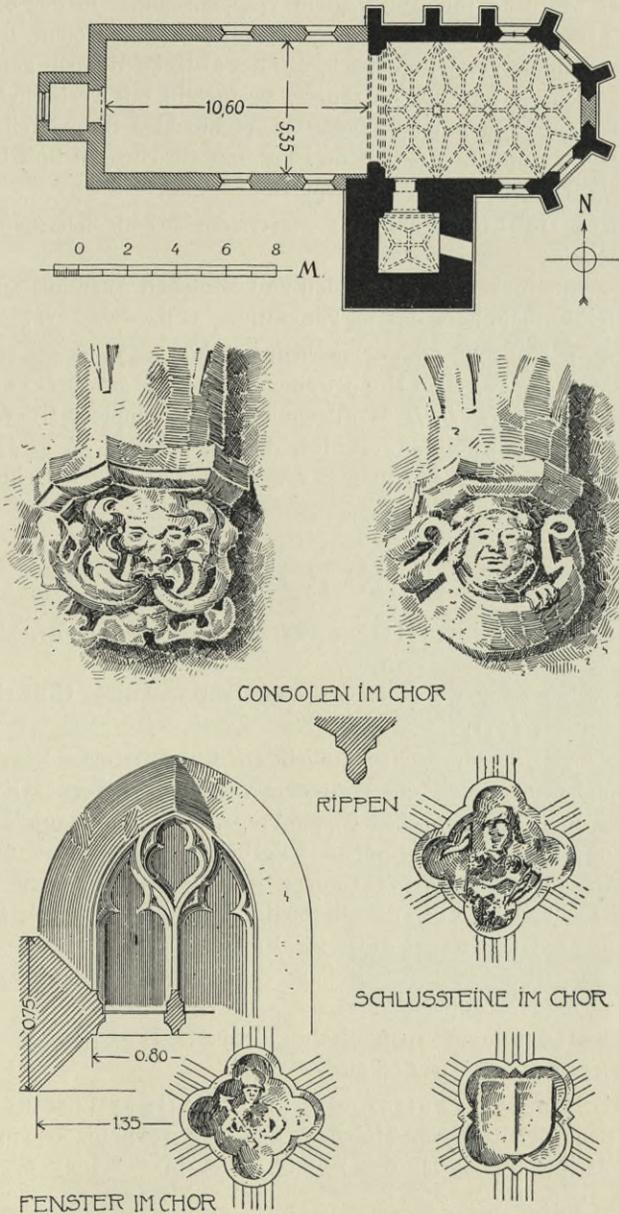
Unterglain. Kirche. Grundriß und Details.
